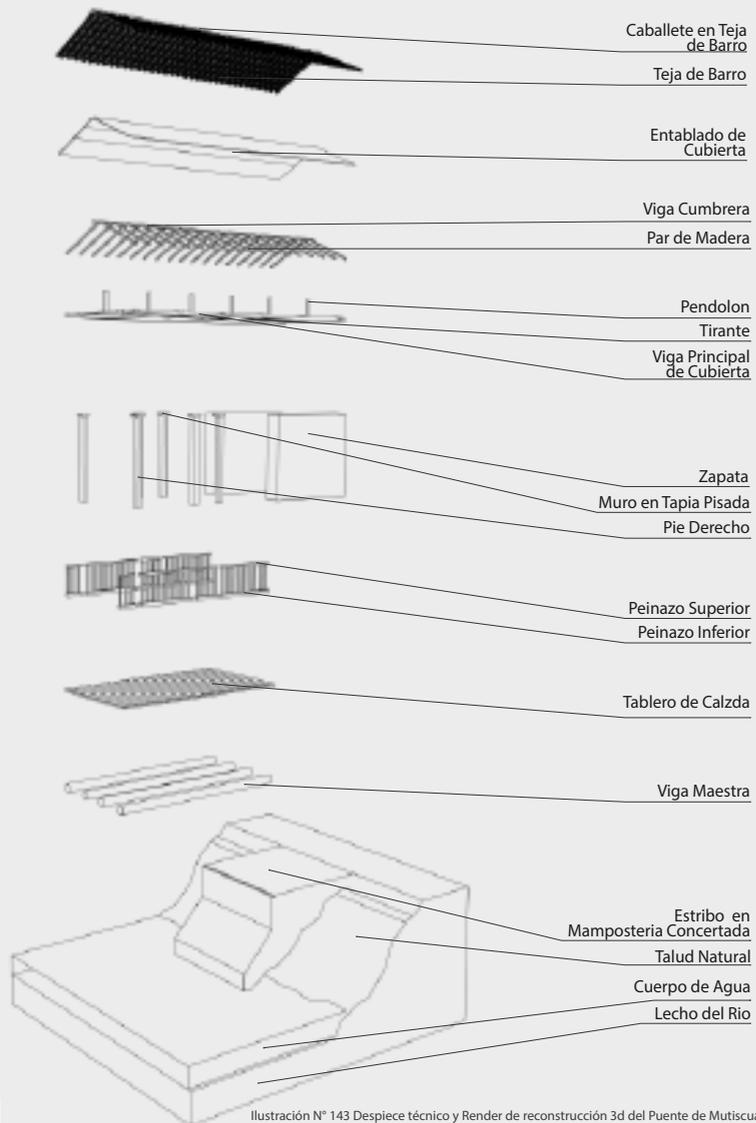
Despiece técnico y Render de reconstrucción 3d del Puente de Mutiscua
